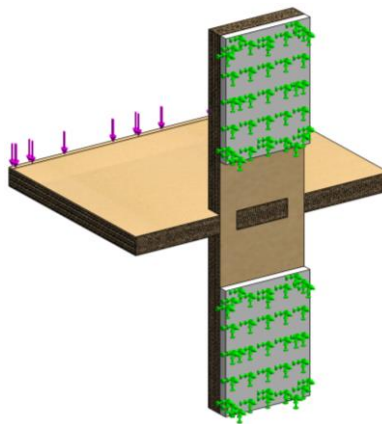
Configuración ensayo de carga estática sobre unión A-PV || Fuente: Elaboración propia
